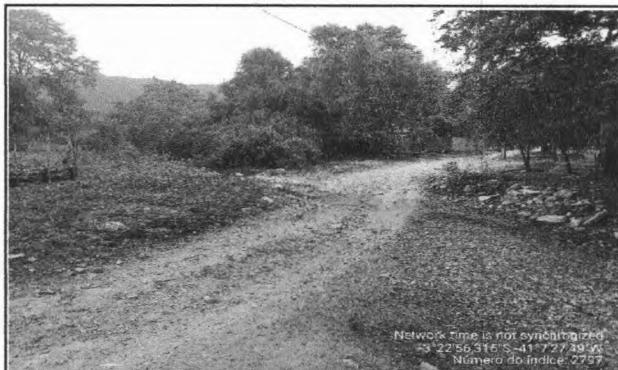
LOCAL DA CONSTRUÇÃO - BUEIRO
